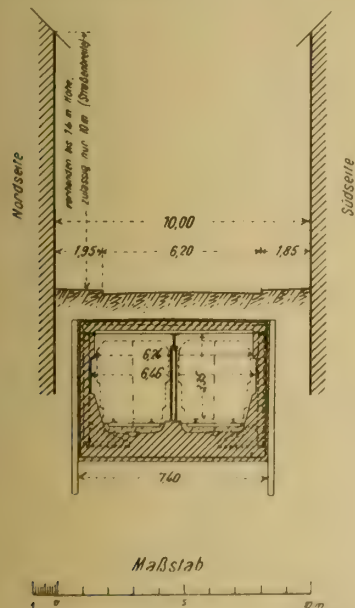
Niederwallstraße mit Untergrundbahn.
